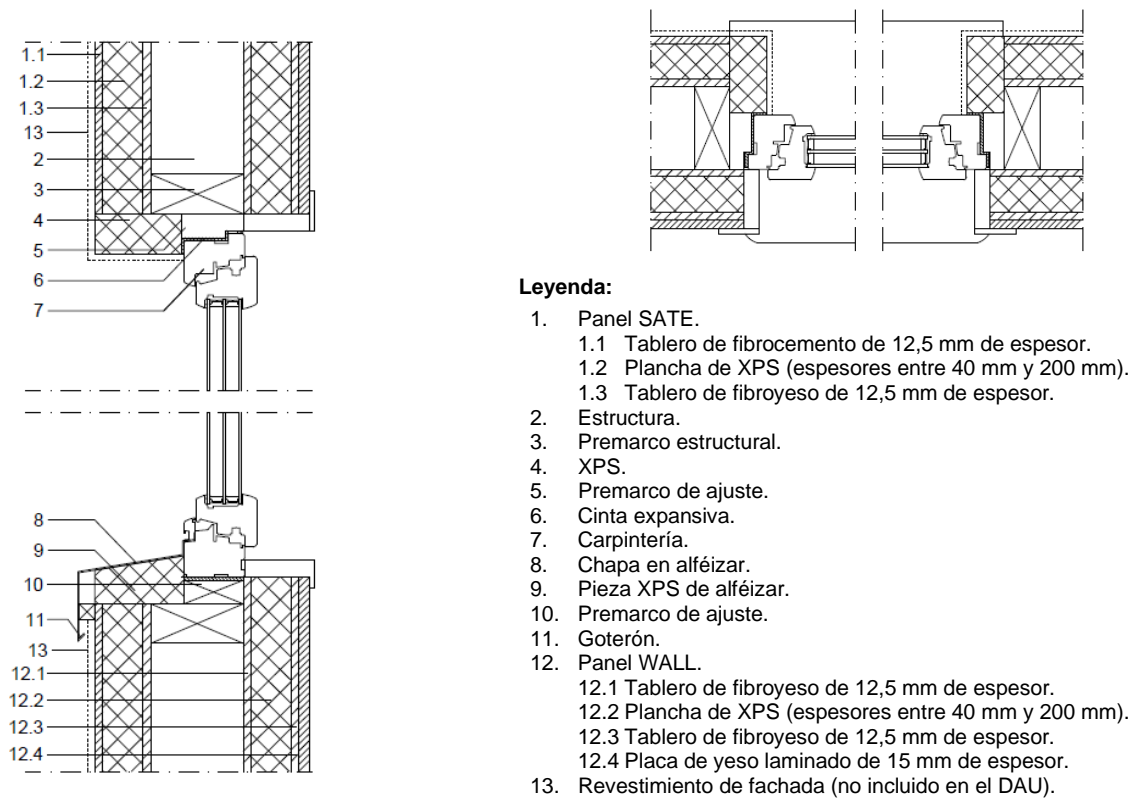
Encuentro tipo de fachada formada con paneles SATE y WALL con carpintería. Sección transversal horizontal y vertical.
